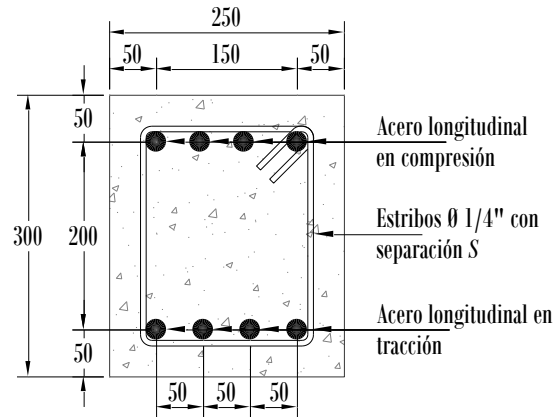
Sección de viga para análisis (dimensiones en mm)
